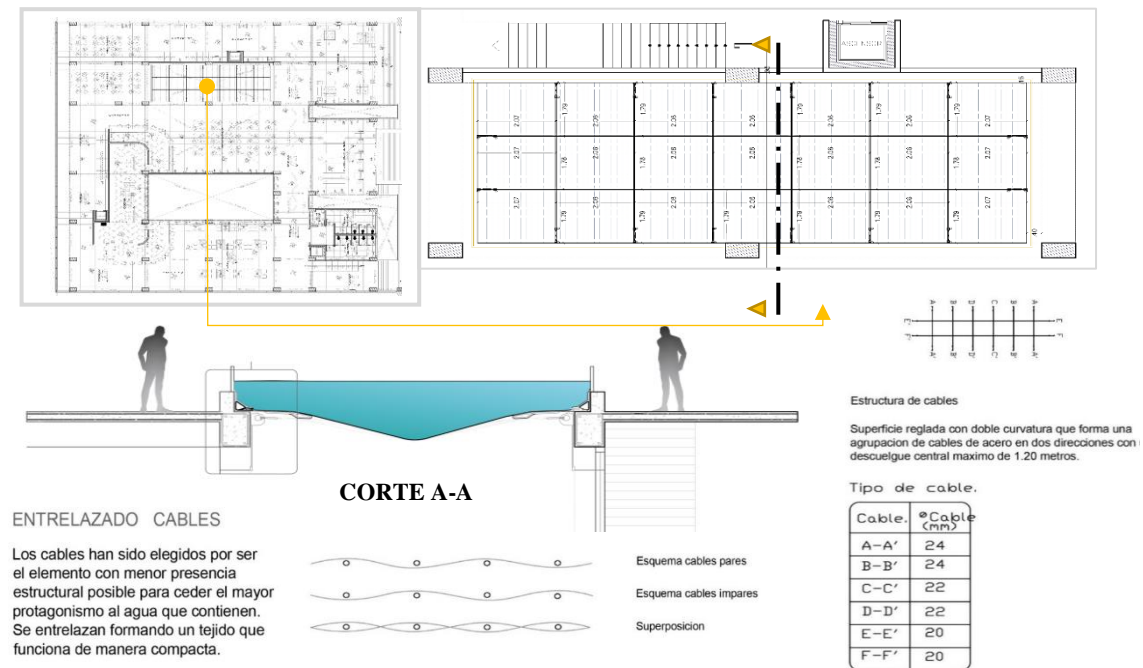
Detalle arquitectónico del techo de agua. Fuente: Elaboración propia. Año: 2017.
